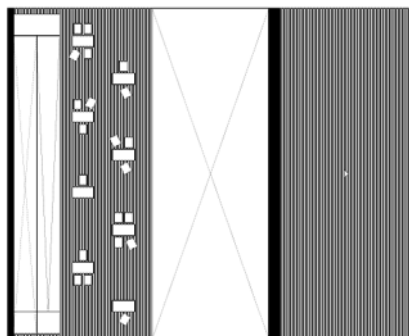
Planta do piso superior do pavilhão proposto.
